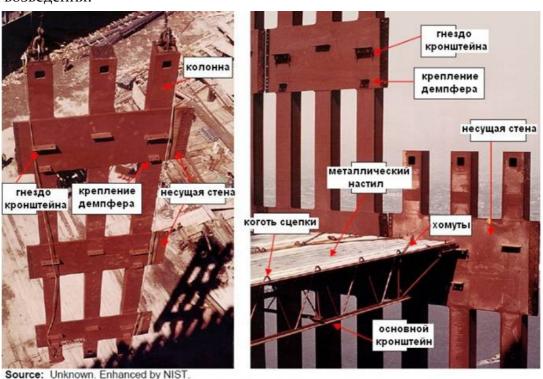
Perimeter column/spandrel assembly and floor structure. Структура сборок периферийных колонн/несущих стен и этажей.
